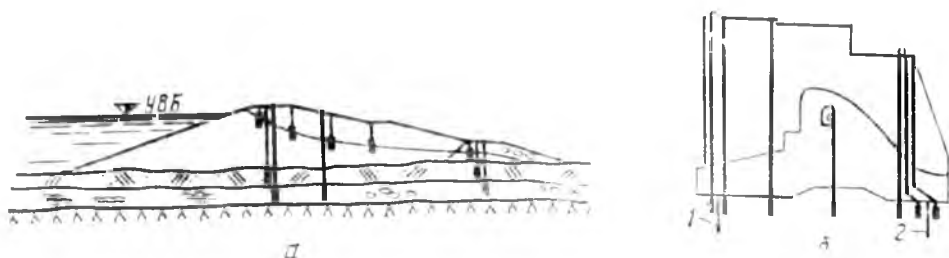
Схема размещения пьезометров: а — грунтовая плотина; б — бетонная плотина на скальном основании; 1, 2 — верховой и низовой шпунты.
